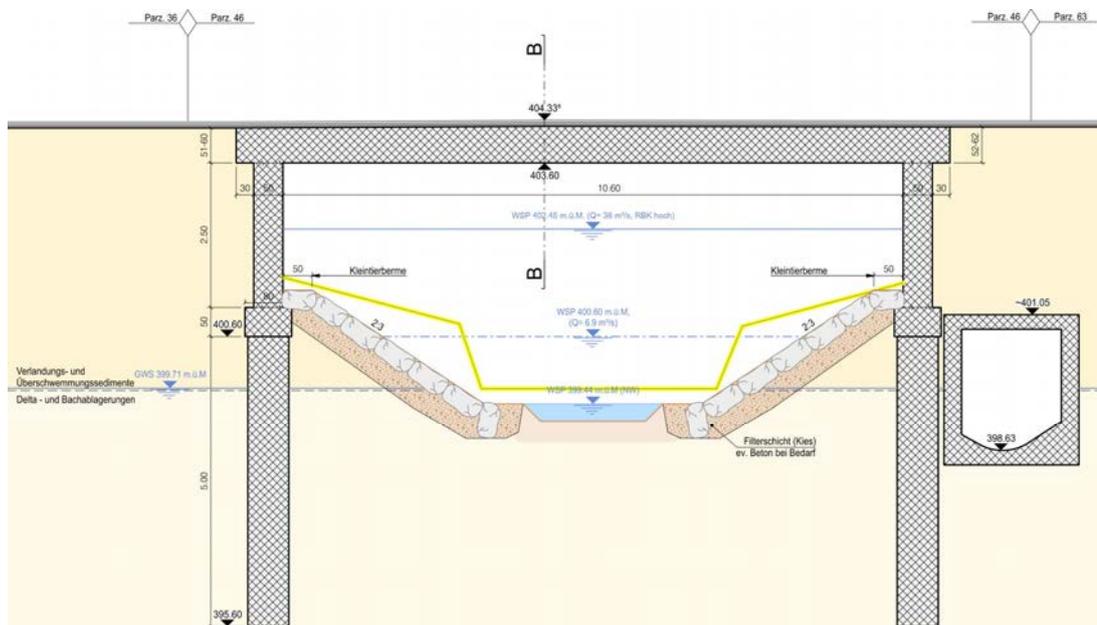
Vertikale Linienführung und Anpassung des Fliessquerschnittes innerhalb der Brücke Bahnhofstrasse, Littenbach
